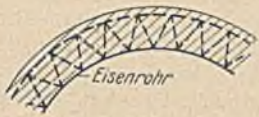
Eisenrohr mit Fachwerk-ringen in Beton.
